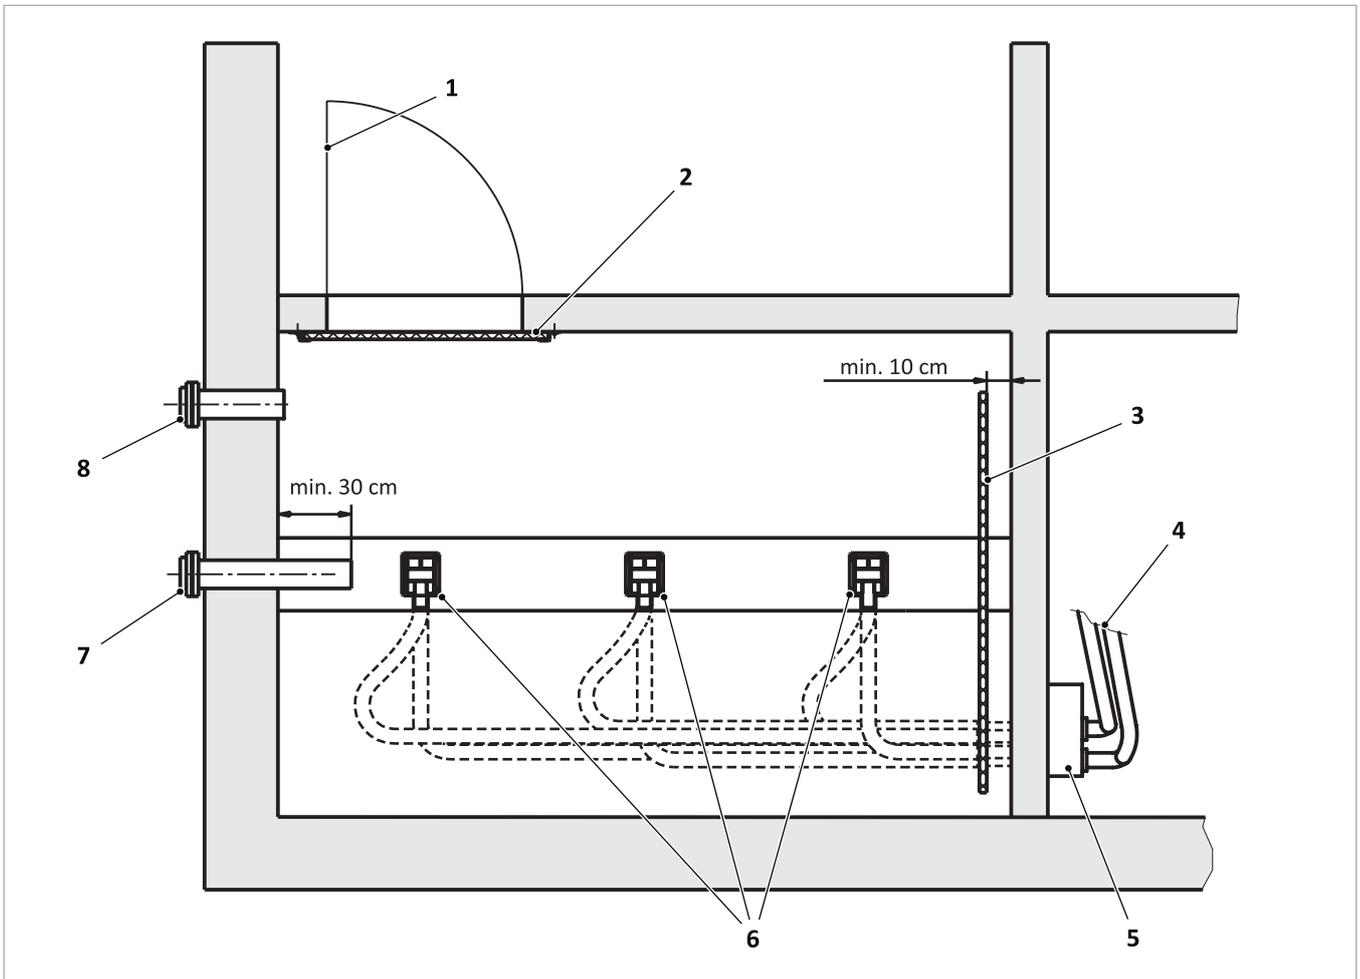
Pellet-Lagerraum – Ansicht von oben
